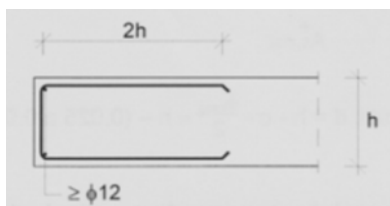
Pormenorização de armadura de reforço em consolas existentes no posto de seccionamento
